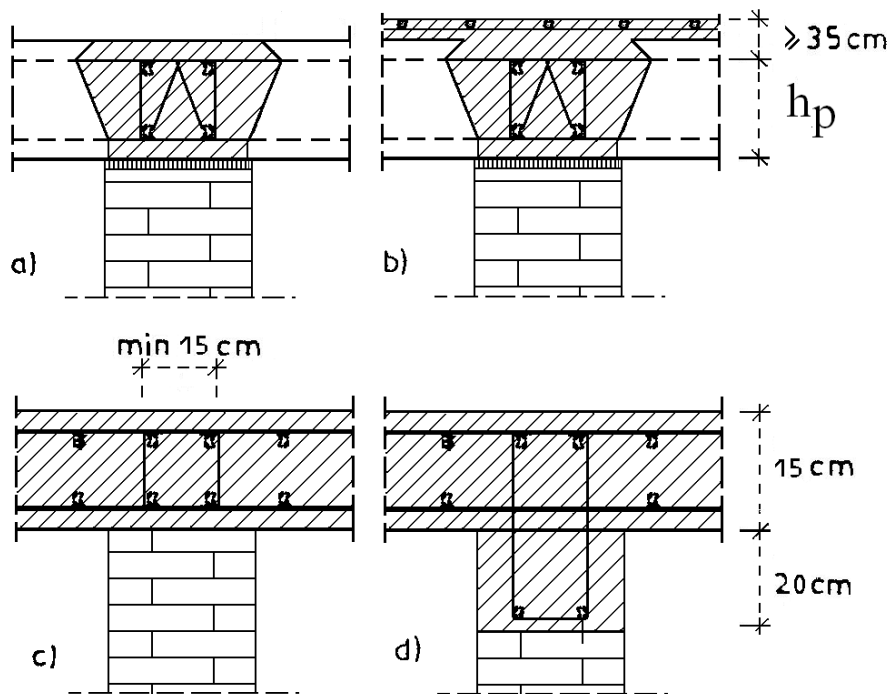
Montage- und Verankerungsgurtungen: a - bei Außenwänden, b - bei Innenwänden; c - Verankerungsgurte; 2 - vorgefertigte Deckenträger; 3 - Stahlbetongurte
